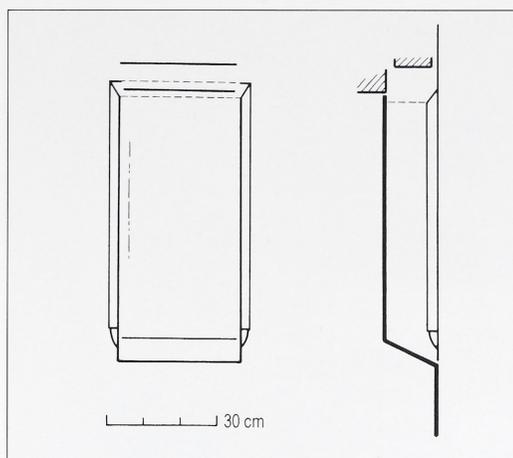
Rottweil, Glückergasse 16. Ehemalige, vermauerte Fensteröffnung aus Stuckmörtel im westlichen Giebeldreieck, sichtbar vom Dachraum des Nachbargebäudes. Ehemalige Außenansicht und Schnitt.
